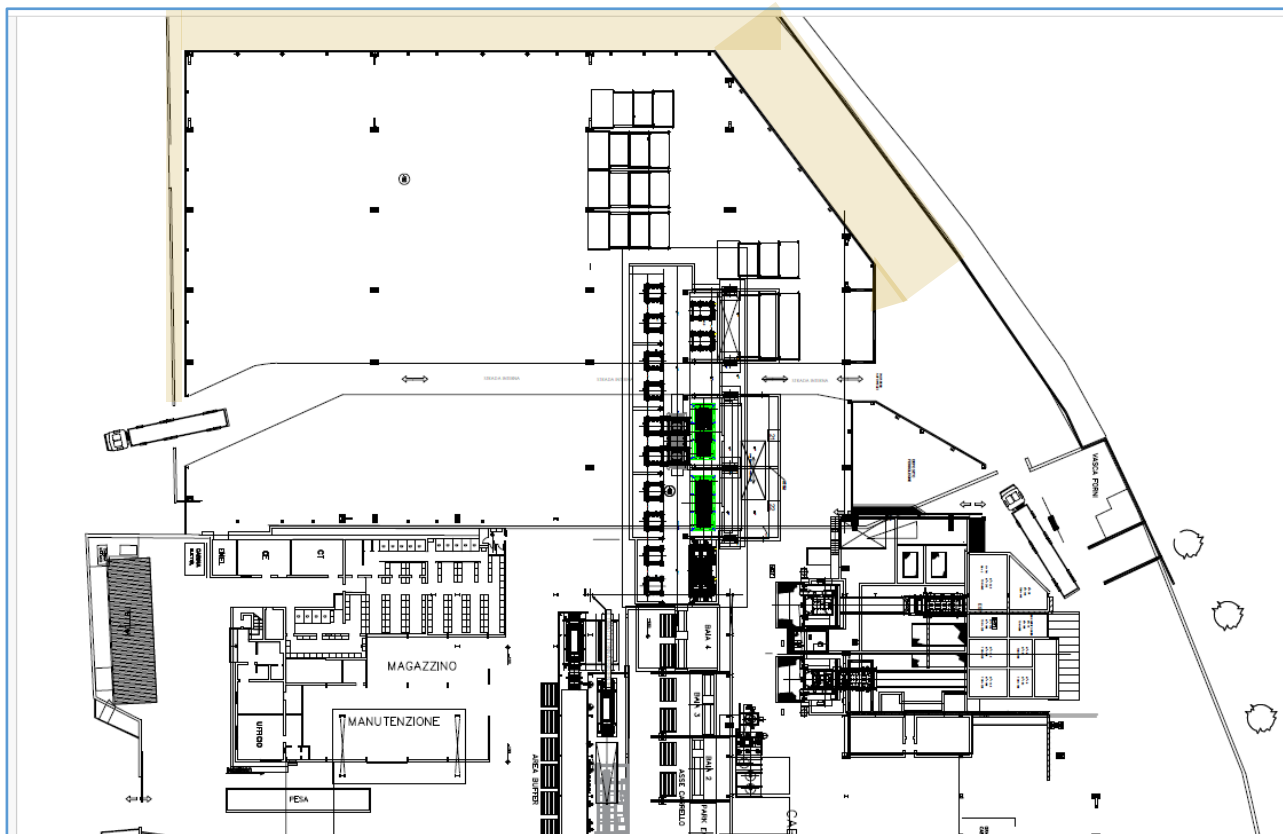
stradina dedicata all'accesso VVF in pavimentazione drenante
